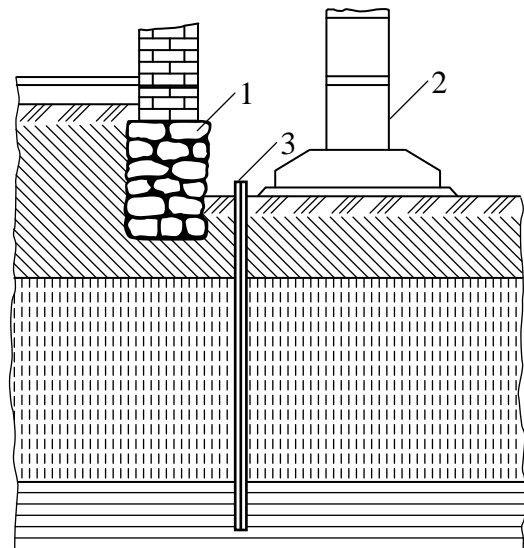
Улаштування роз’єднувальної шпунтової стінки: 1 – існуючий фундамент; 2 – фундамент нової споруди; 3 – роз’єднувальний шпунт
